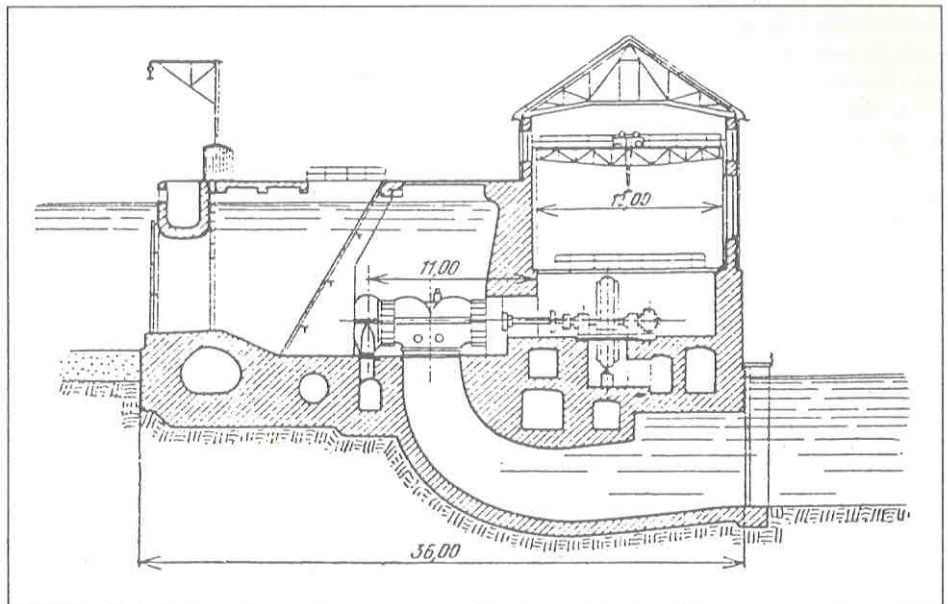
Sección transversal de la planta en Mendoza, Argentina (canal cacique)
